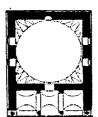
مسقط أفقى لجامع أحمد باشا فى أنقرة (عن : Kuran)
